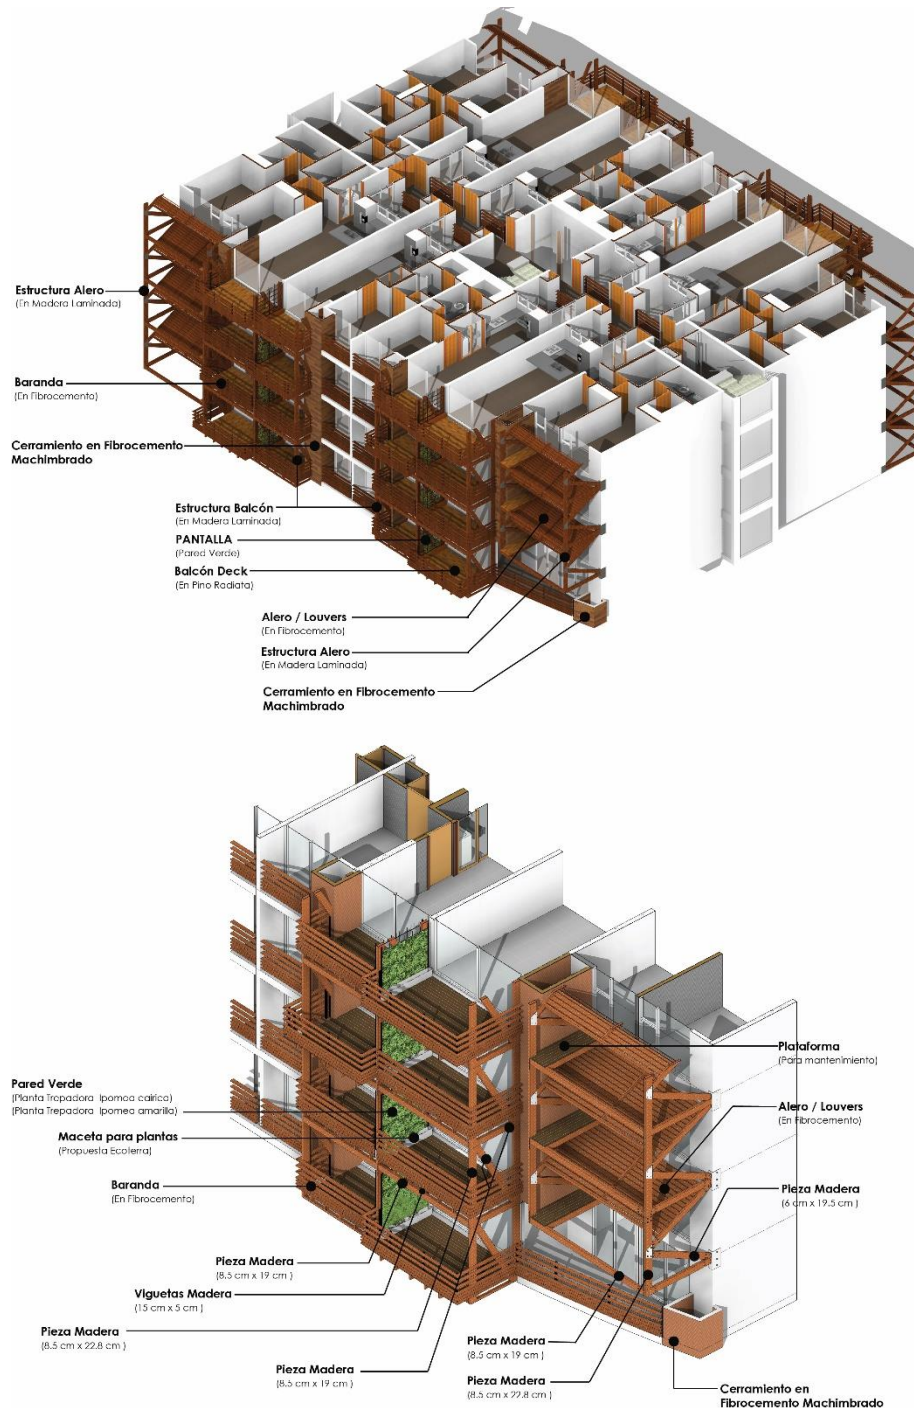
Detalle de Estructura colocada en fachadas en madera laminada. Fuente: Elaboración propia
